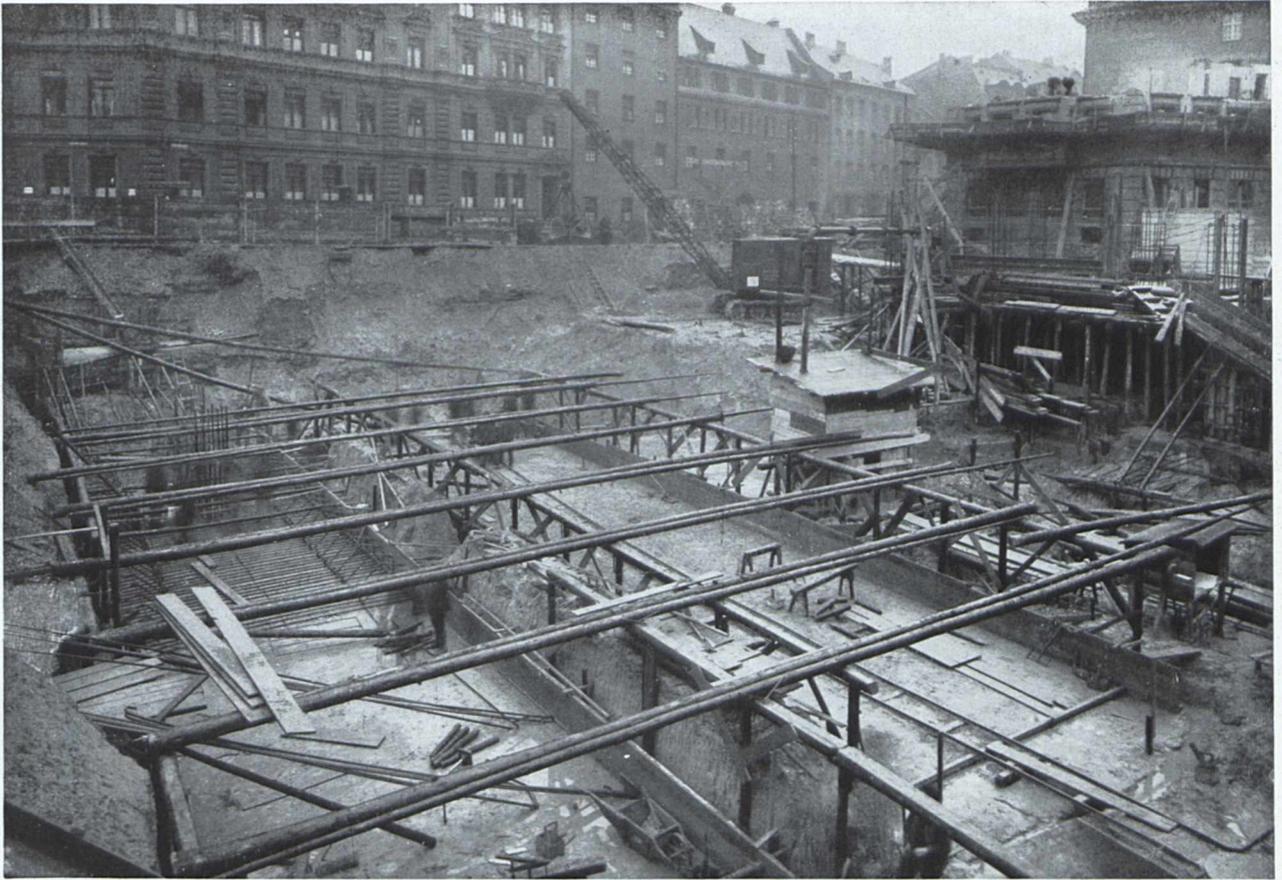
Bauausführung : Karl Stöhr, Bauunternehmung, München, Schwanthalerstraße 11
